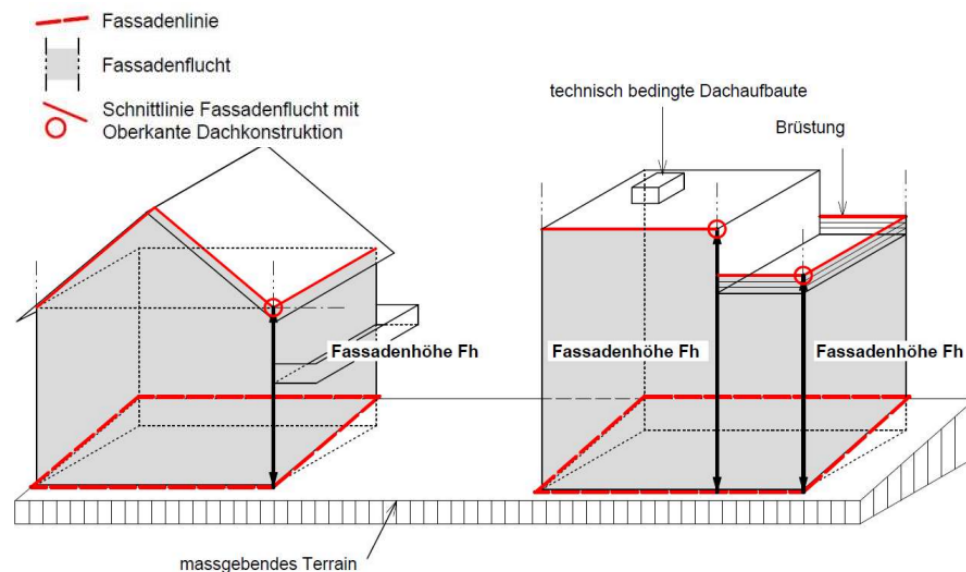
Fassadenhöhe gemäss KBV Anhang I, Figur 6
